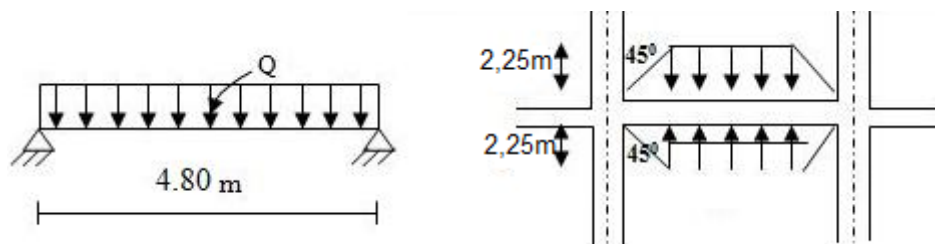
schéma statique et distribution des charges sur les poutres secondaires
